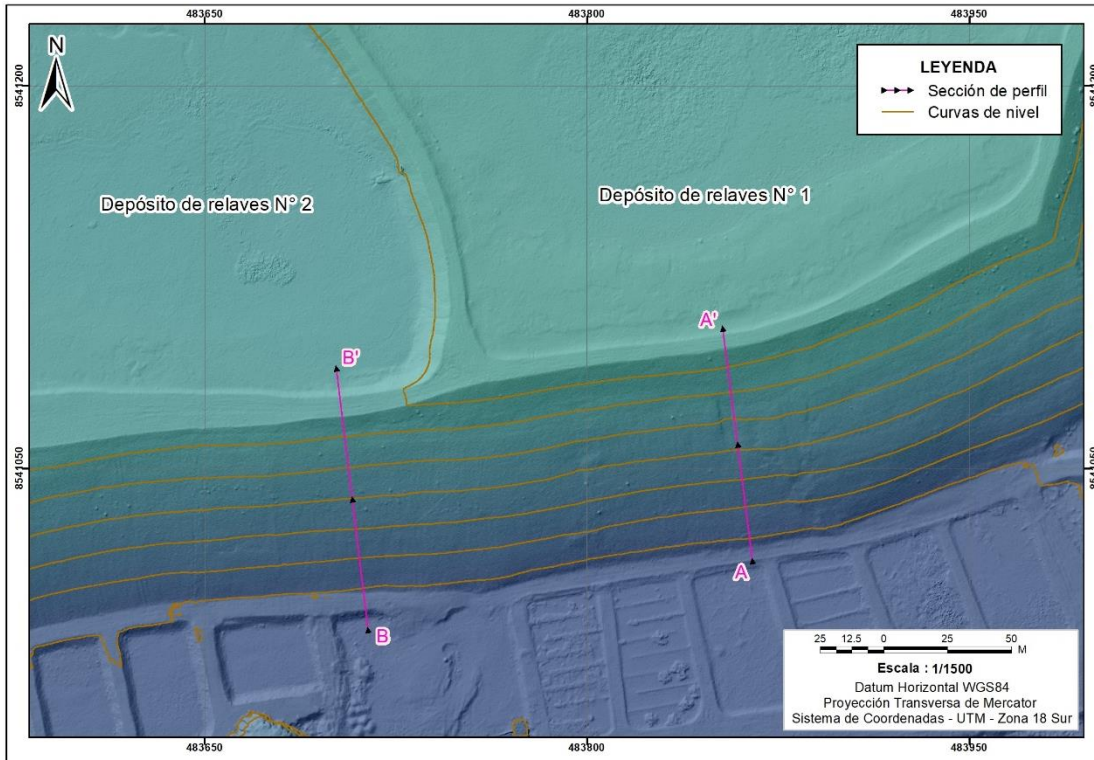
Perfiles longitudinales en el ámbito de la UF San Genaro
